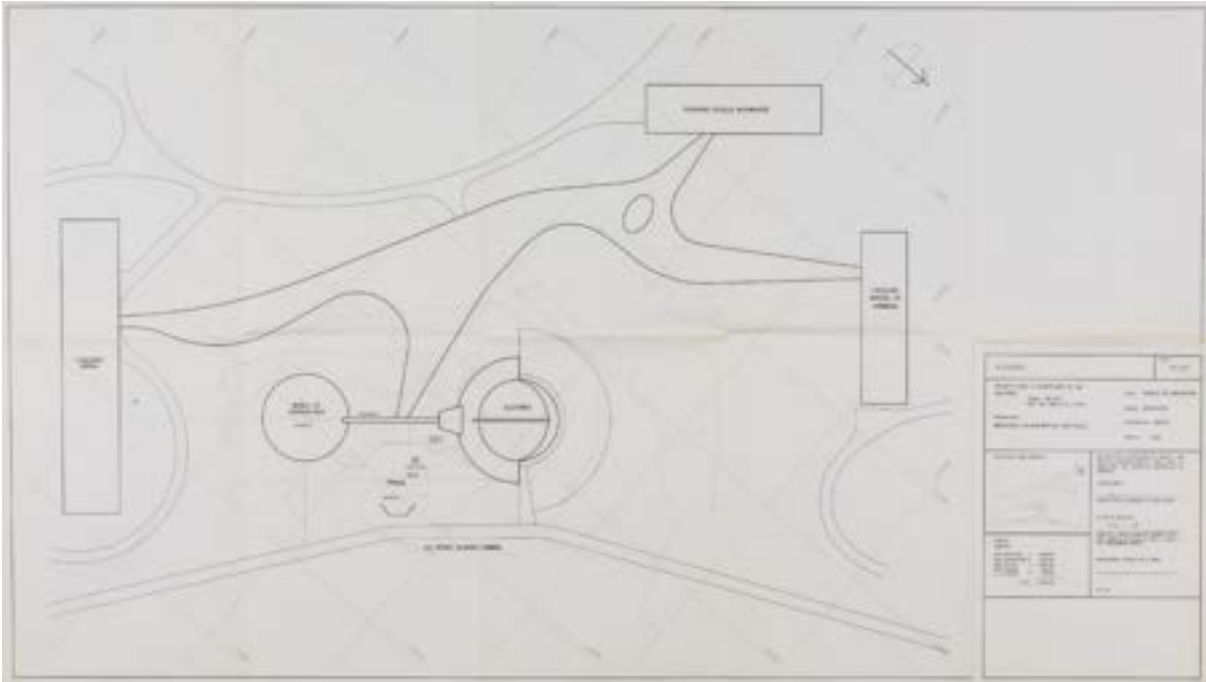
Projeto de aprovação – Subsolo – foto Rafael Schmidt – fonte: Acervo do DEPAVE
